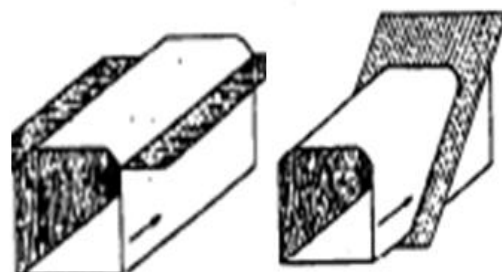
Gabarit da 1ª Fase de escavação e utilização de escavadora hidráulica de 28 ton. e martelo de 2,5 ton.
